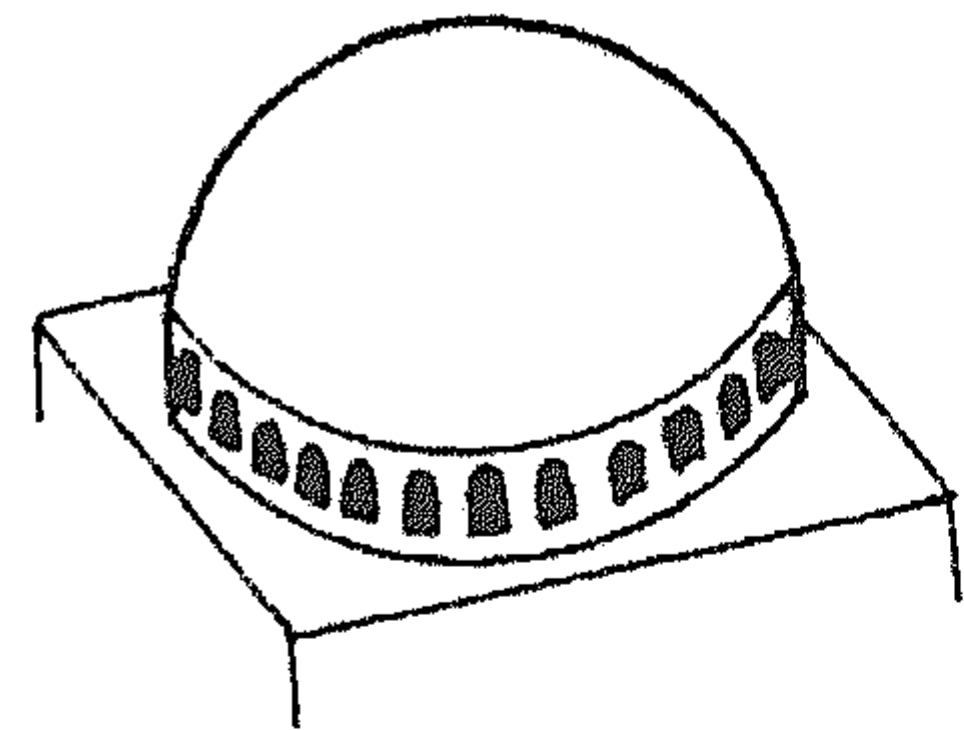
قبة رومانية على مسقط أفقي
